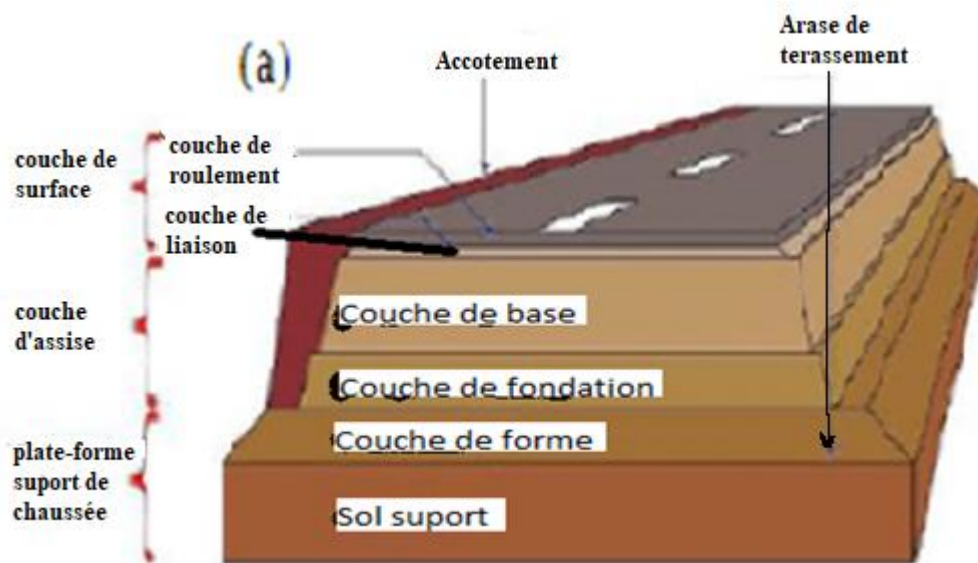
Différentes couches d'une chaussée dans le cas de chaussée semi-rigide
